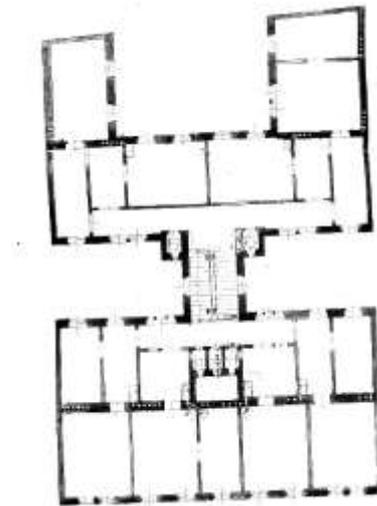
Grundriss Liechtensteinstraße 94
